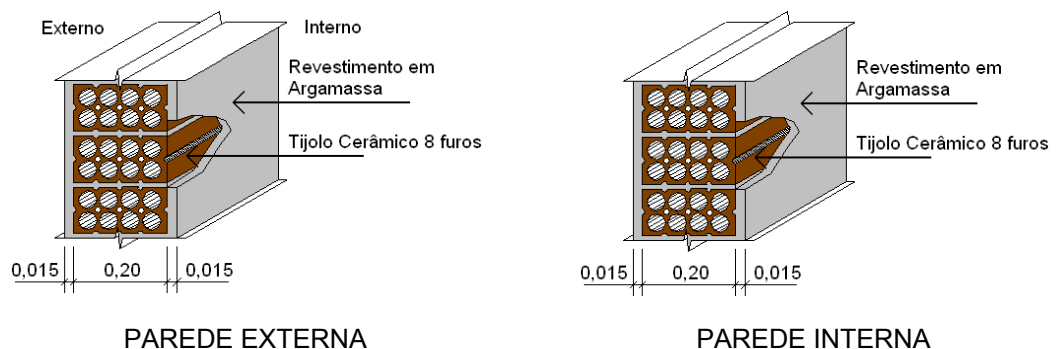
Detalhe construtivo das alvenarias externa e interna - Ambiente 1.
